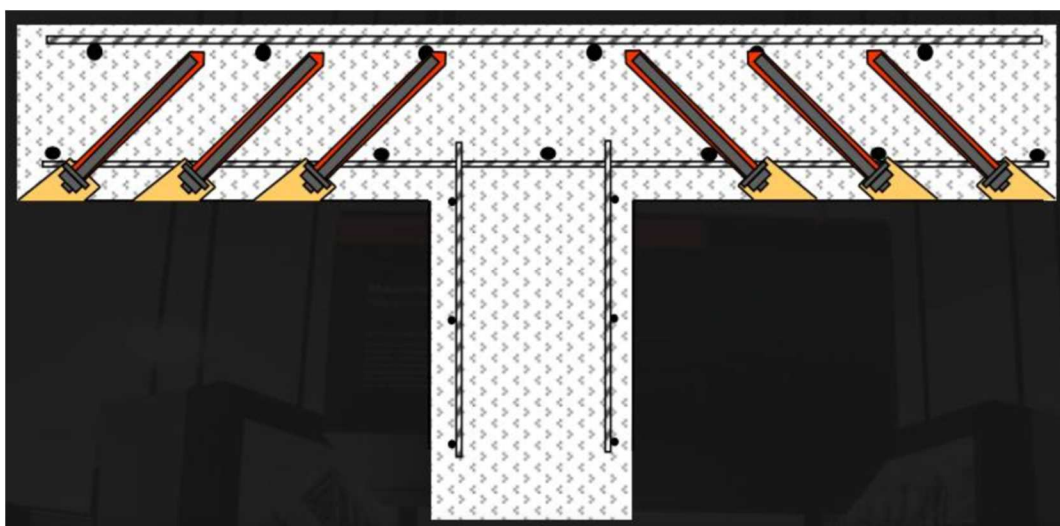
Усиление плит перекрытия от продавливания стержнями Hilti HZA-P
